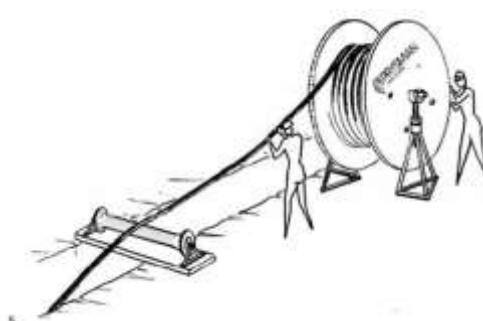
Detalle máquina de tiro y entrada de cable en zanja
